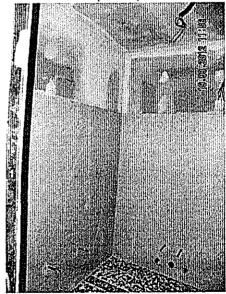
Stanza 1.7- Bagno, Particolare interno con impianti posati
